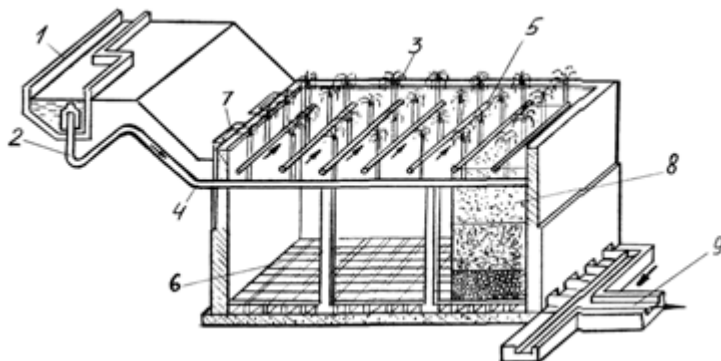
Биологический фильтр: 1 – дозирующий бак; 2 – сифон; 3 – спиральная насадка для разбрызгивания; 4 – магистральный трубопровод; 5 – распределительные трубы; 6 – дренаж из плиток; 7 – каналы для входа воздуха в дренаж; 8 – фильтр из шлака; 9 – канал для отвода очищенной воды
